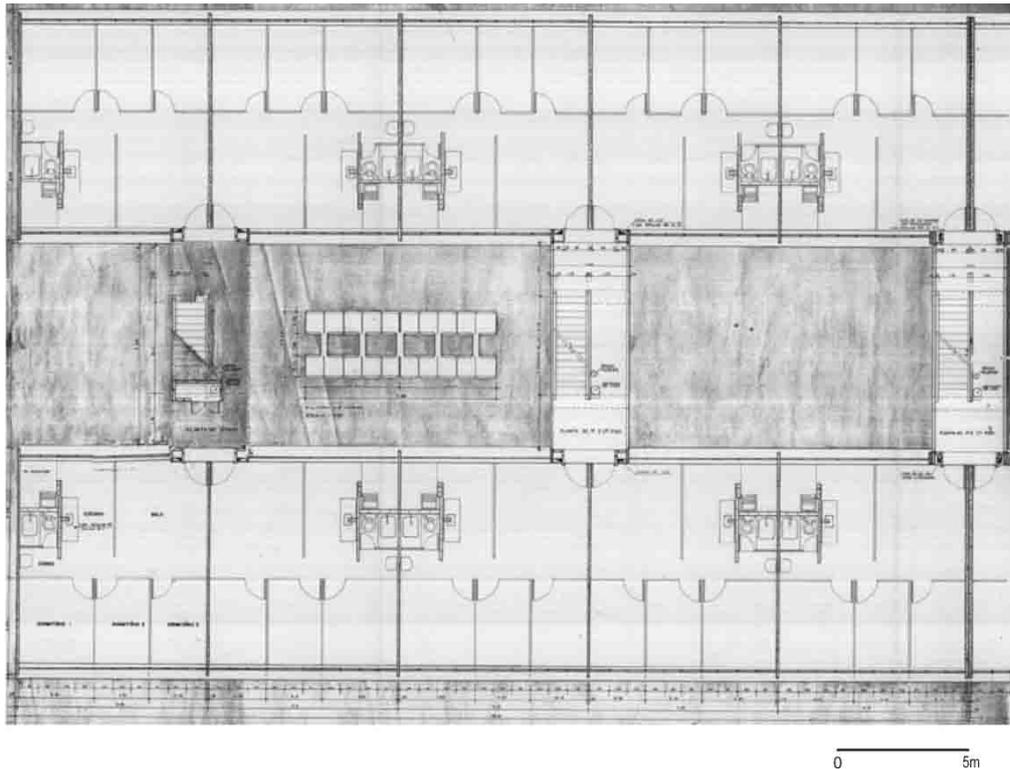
Planta del piso tipo 3ª etapa (Fuente: <sup>11</sup>)
